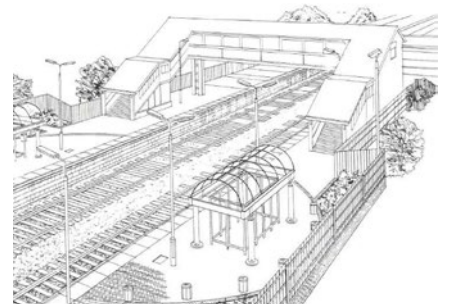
Disegno e pianta di una stazione rurale tratto da Edwards B. *The Modern Station*.
